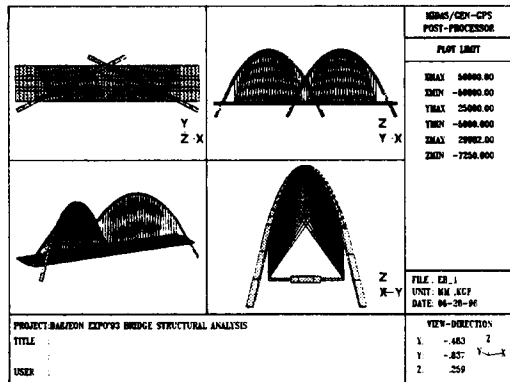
3-D Model 및 평면도, 정면도, 측면도 (대전 Expo'93 Bridge)
